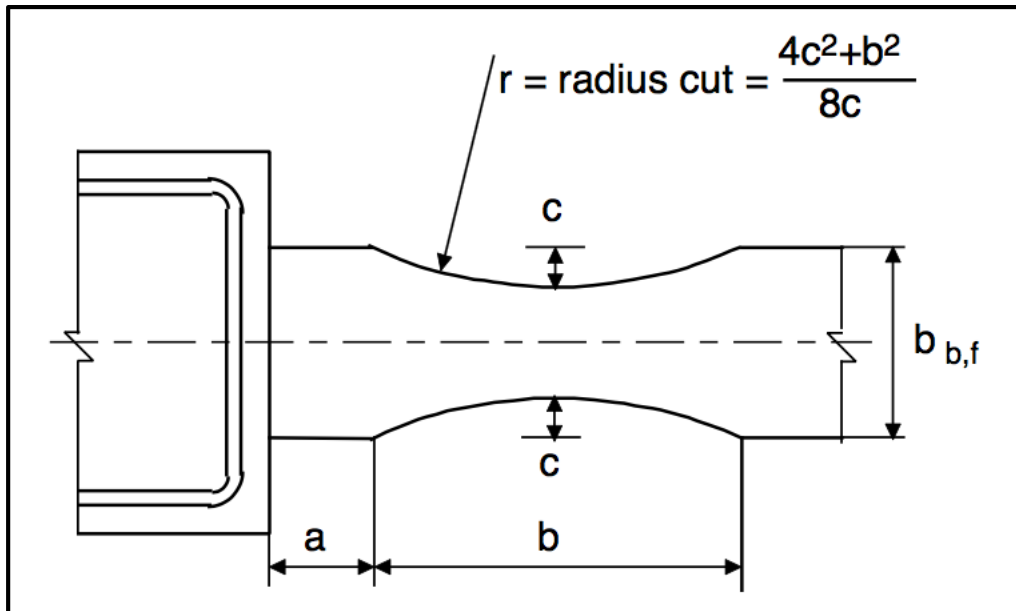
Dimensiones de la reducción de la sección. (Packer, DESIGN GUIDE FOR STRUCTURAL HOLLOW SECTION COLUMN CONNECTIONS, 2004)
